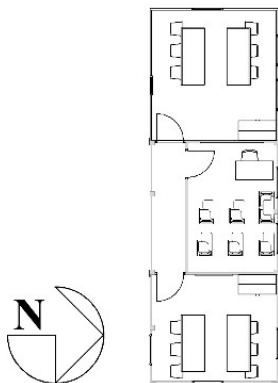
Planta Edificio 4, Zona 1, sin escala.
